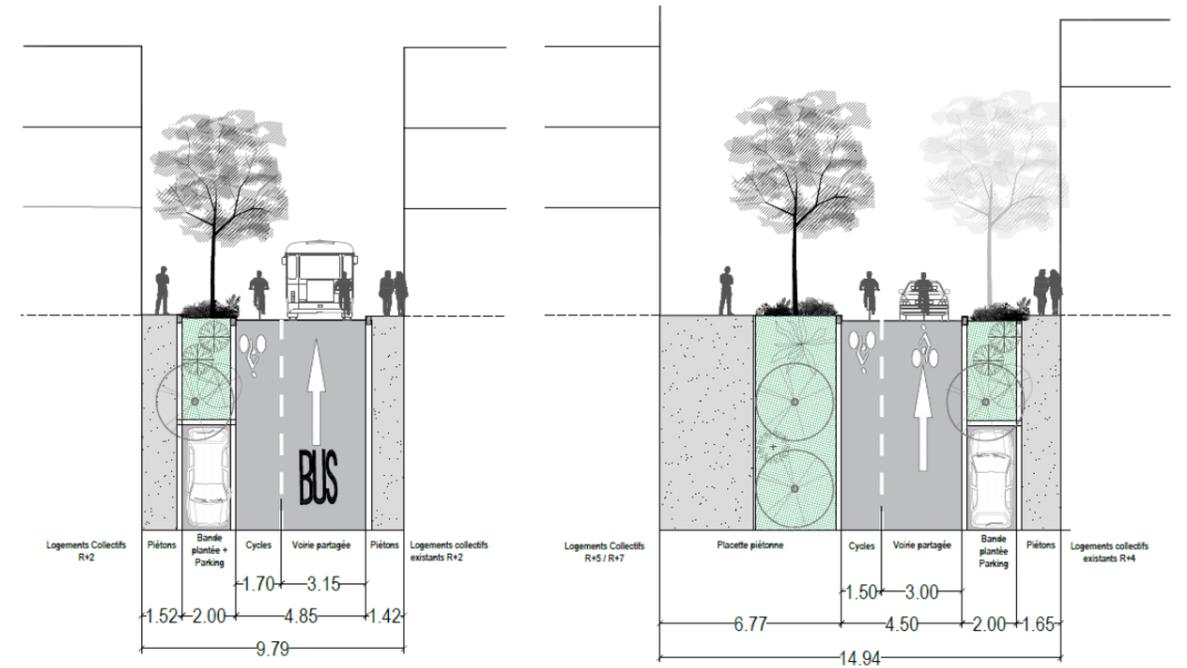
Rue Dubois Crancé- Section étroite et section placette – Coupe 17 et 18
